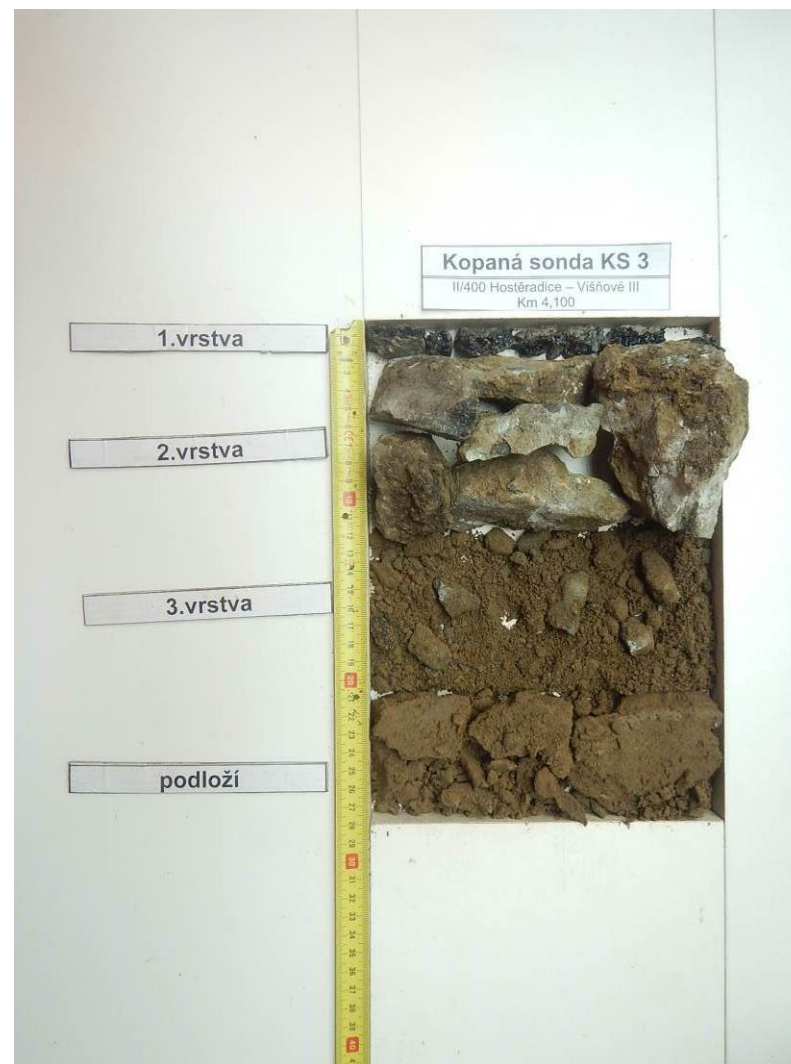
a č. 6 - Kopaná sonda KS 3
